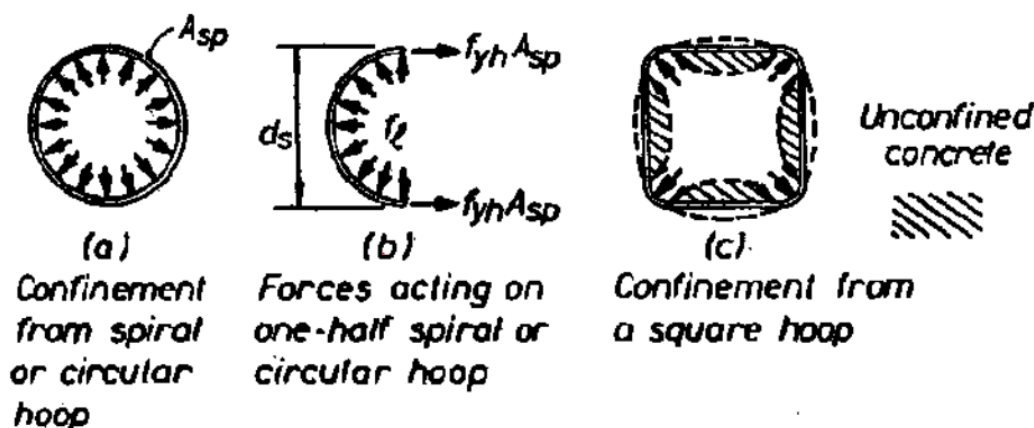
Confinamiento de Concreto por estribos Circulares y Cuadrados (Paulay y Priestley, 1992, p. 99)
